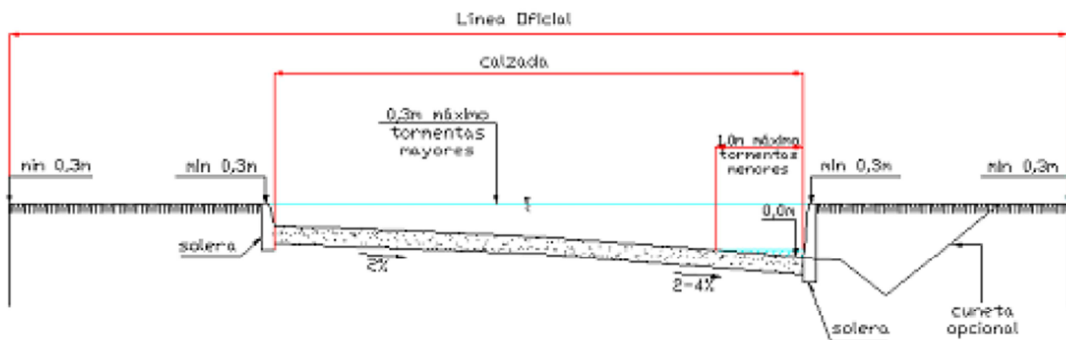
Nivel de escurrimiento Calle Tipo B
